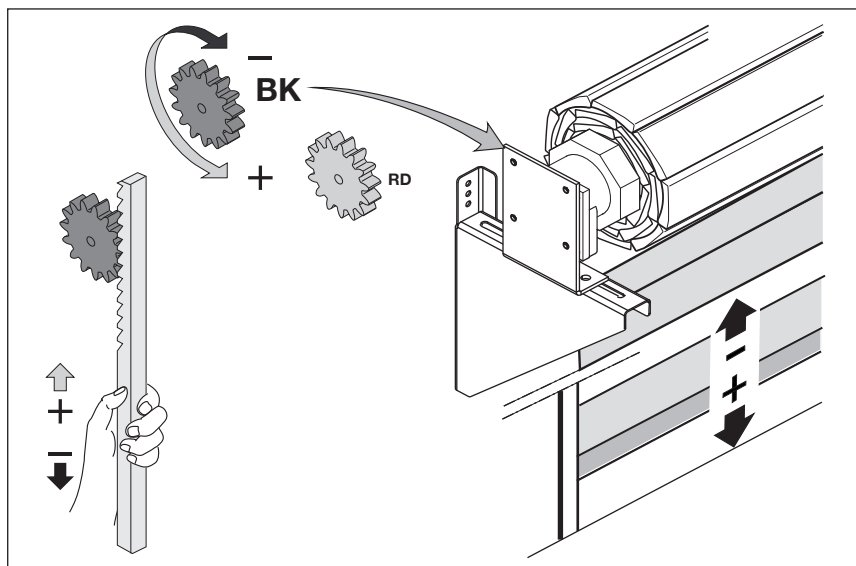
Винт с рифленой головкой BK для конечного положения *Ворота Закр.*, приспособление для регулировки
